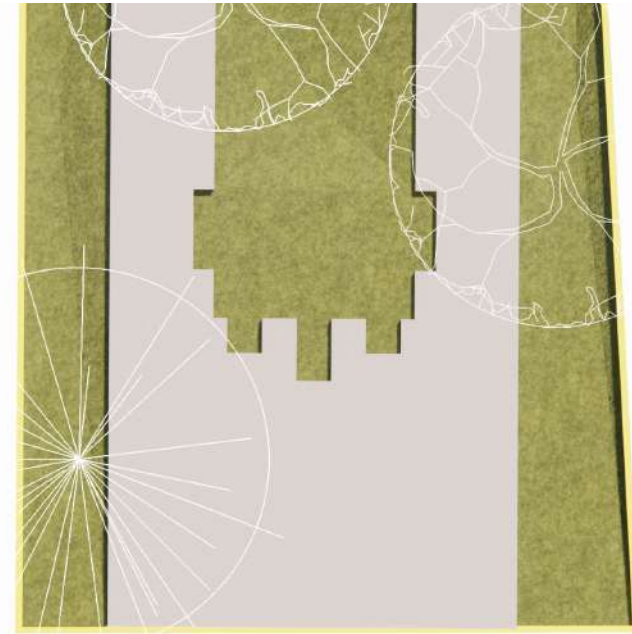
Tramo 8 propuesto. Fuente: Elaboración propia
